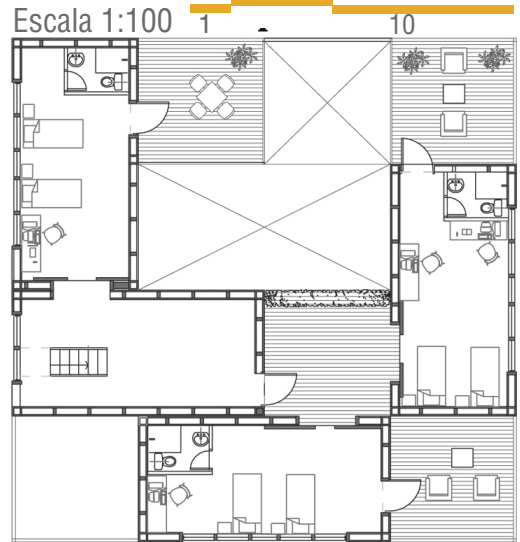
Planta de cuarto piso/ *Fourth floor plan
